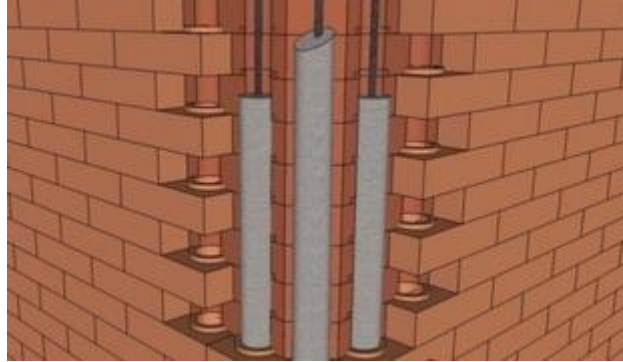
Ilustración elementos verticales, sistema constructivo Siconte
